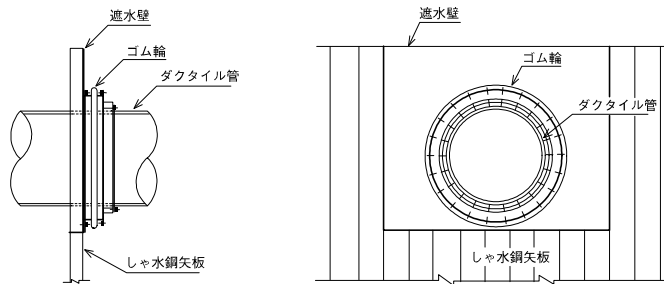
ダクタイル鋳鉄管のシャ水工の構造例
